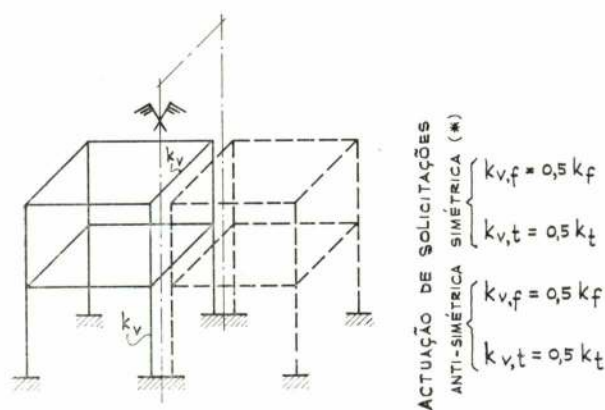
Simplificações por virtude da simetria da estruturas (barras de secção constante)
